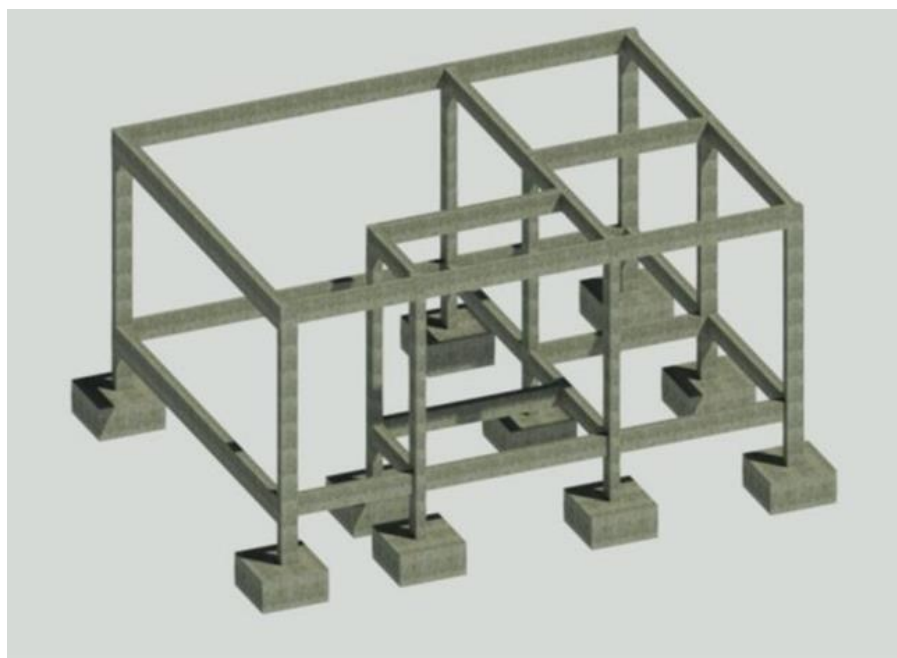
Modelo tridimensional do quadro estrutural em concreto.
